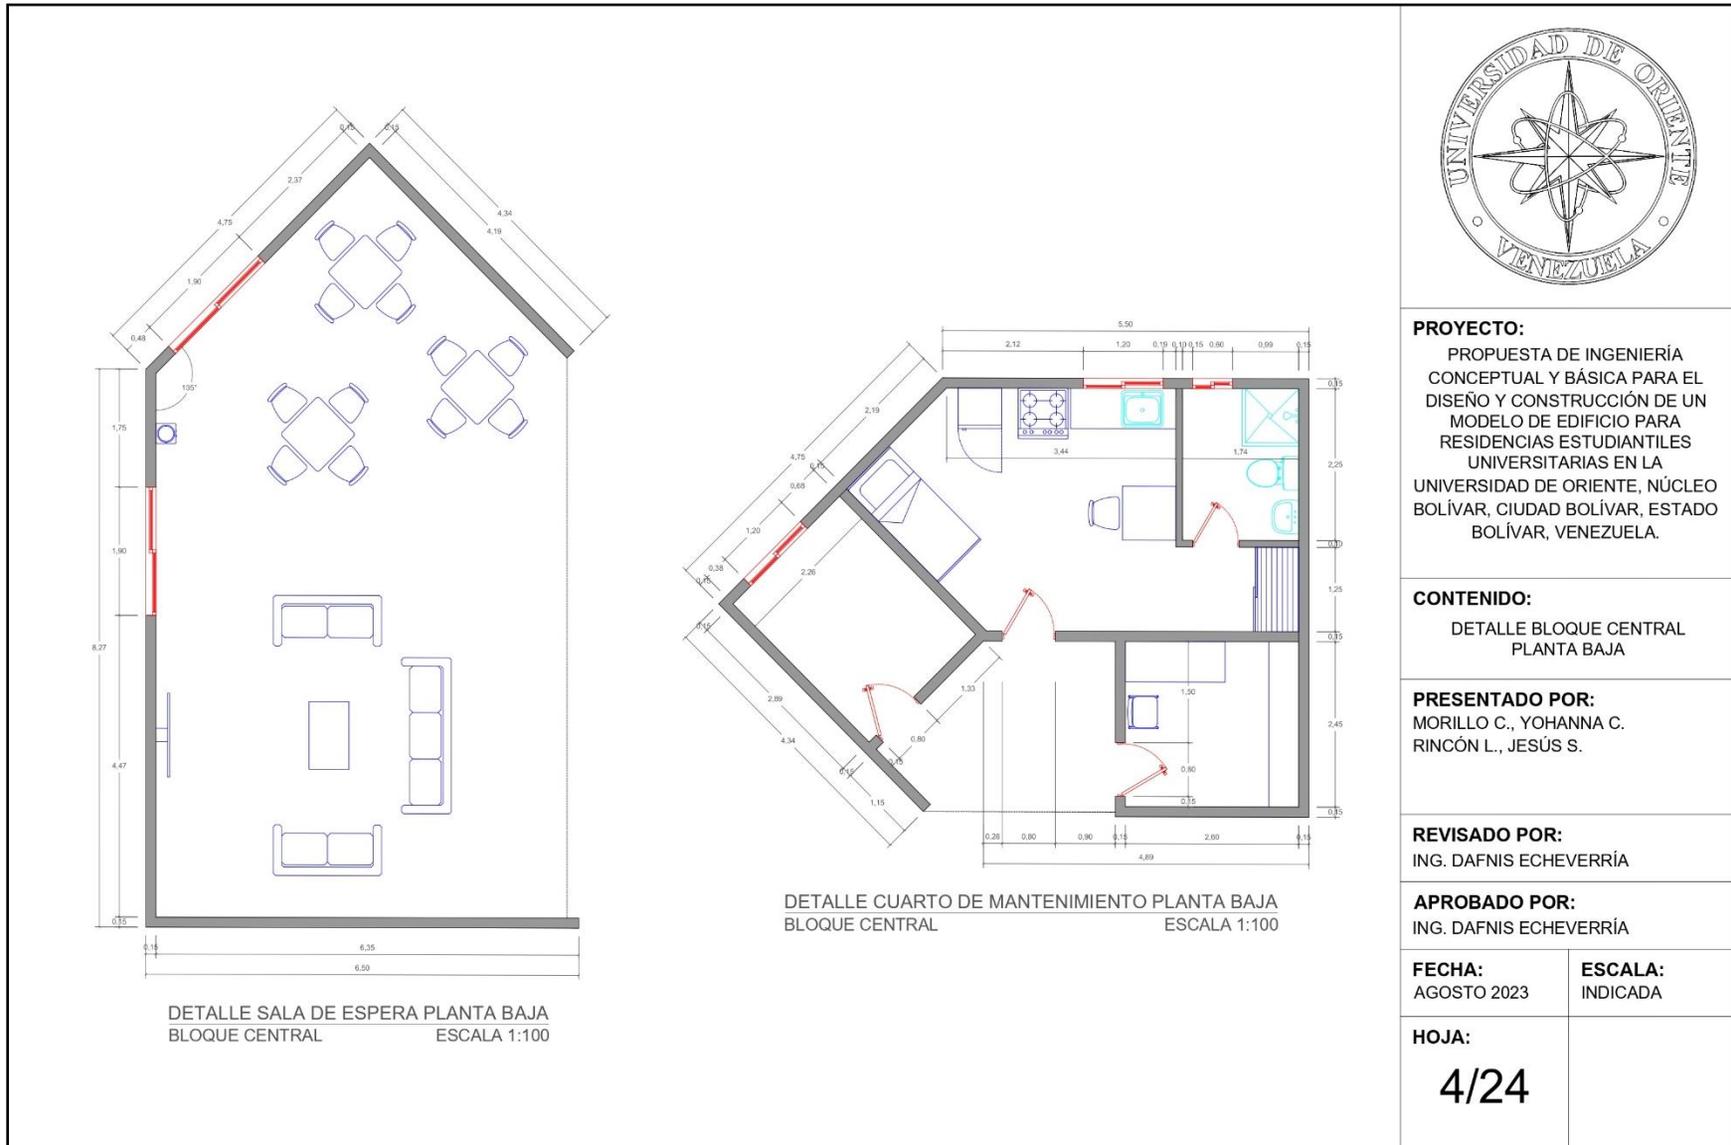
Plano de Detalle. Bloque central, planta baja.
